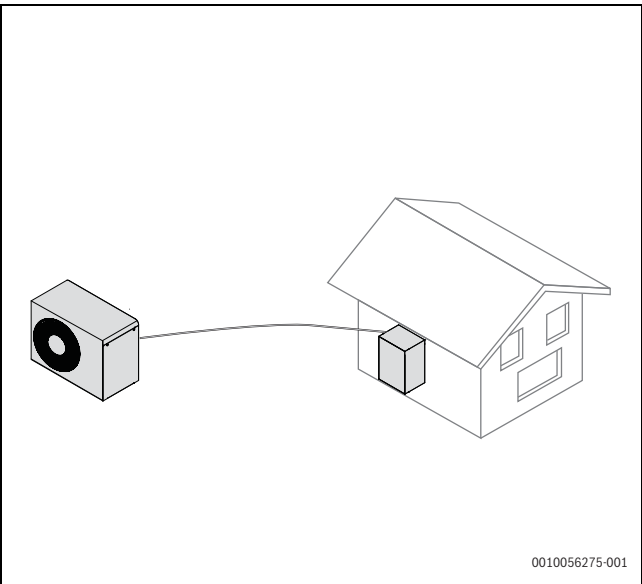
Collegamento CAN-BUS tra l'unità interna e l'unità esterna
